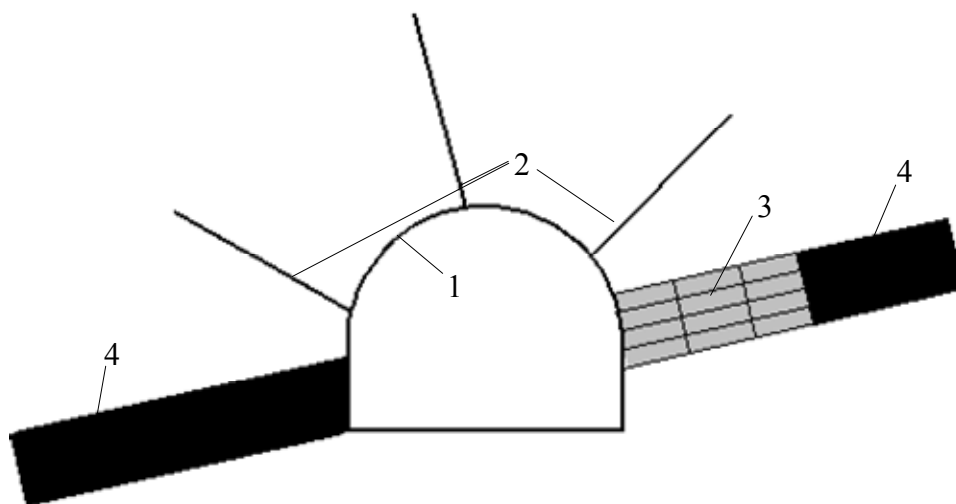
Схема нового способа повышения устойчивости подготовительных выработок на больших глубинах: 1 – арочная крепь; 2 – анкерная крепь; 3 – охранная конструкция из железобетонных плит; 4 – будущие лавы.
